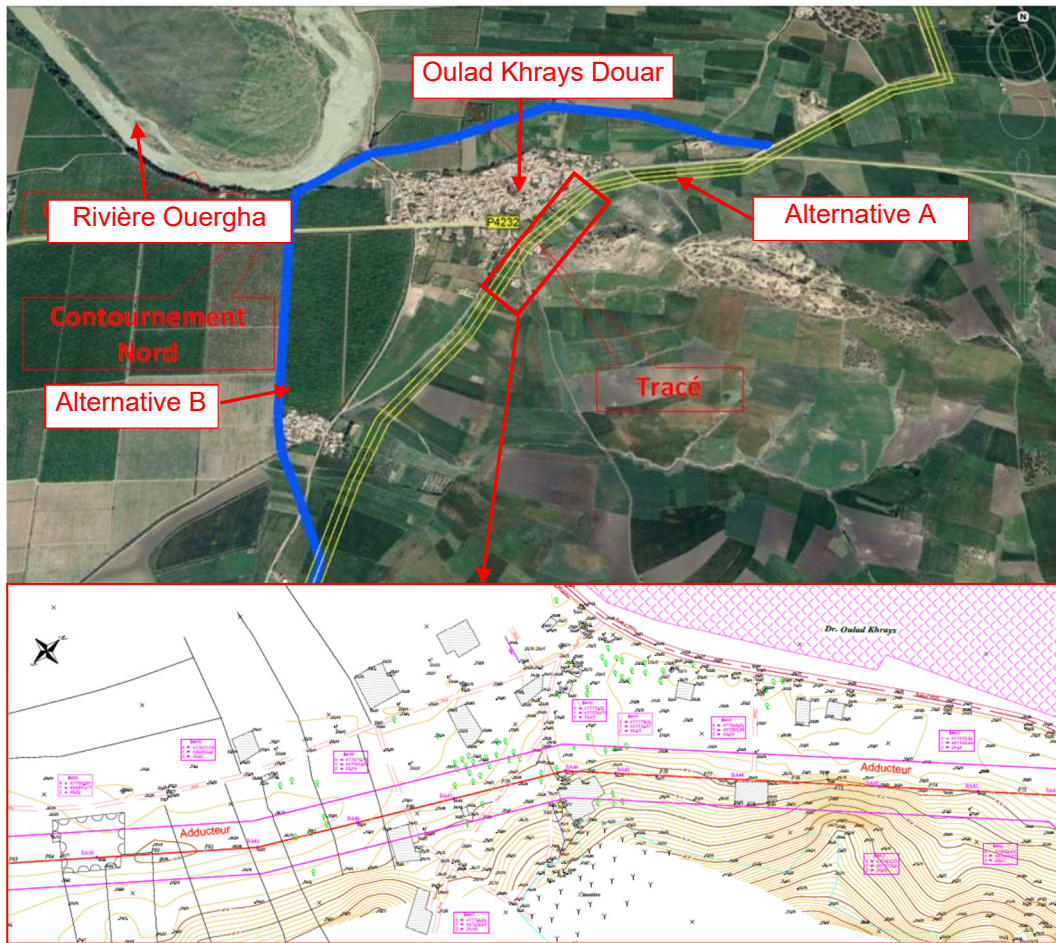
Plan du premier adducteur principal (adducteur Tête Morte) près de Douar Oulad Khrays
